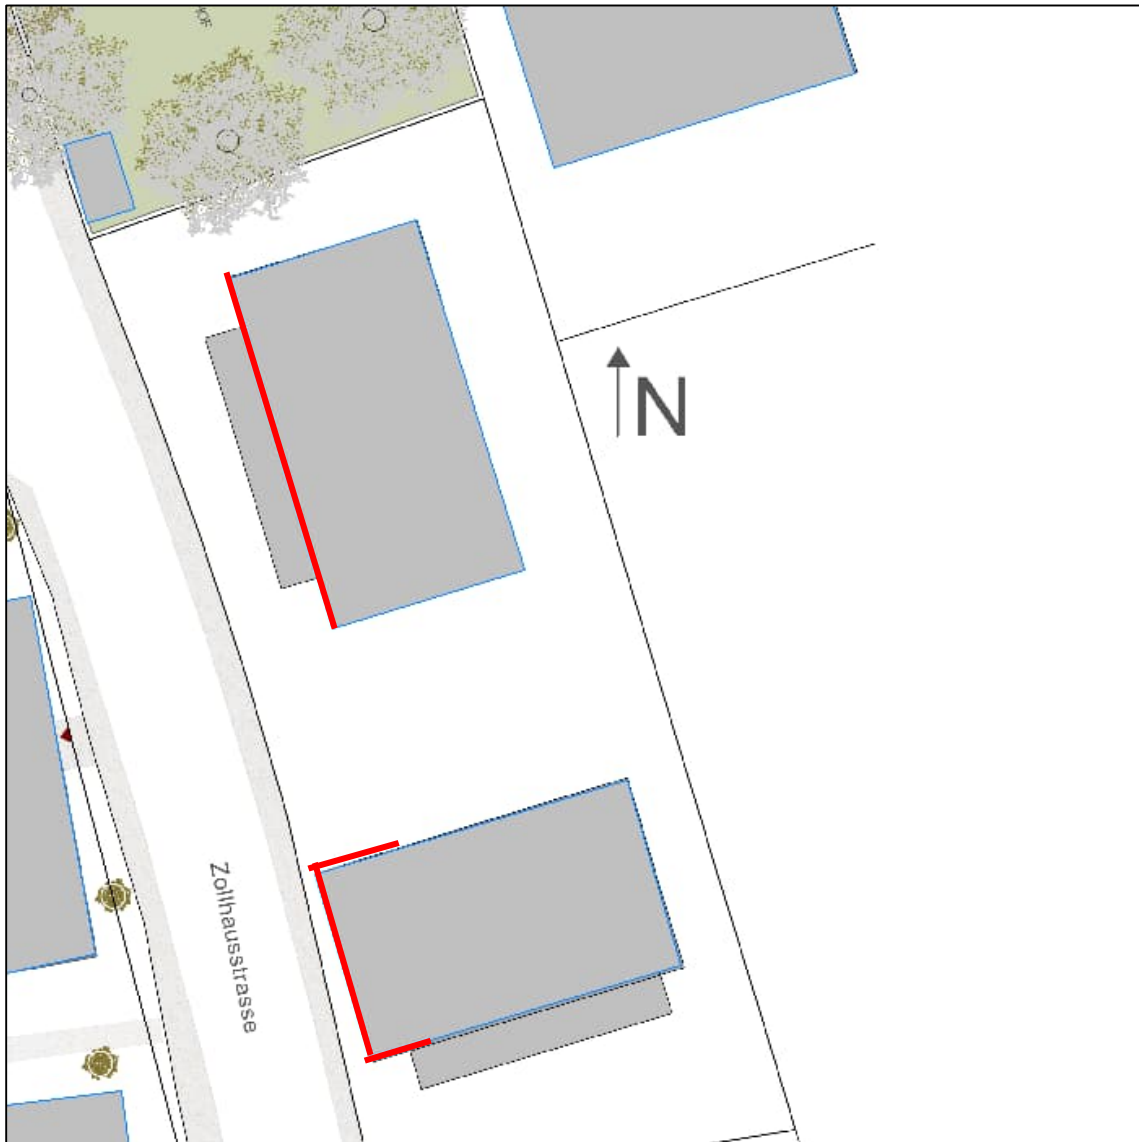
Darstellung des Geltungsbereichs mit Kennzeichnung der betroffenen Fassadenabschnitte
